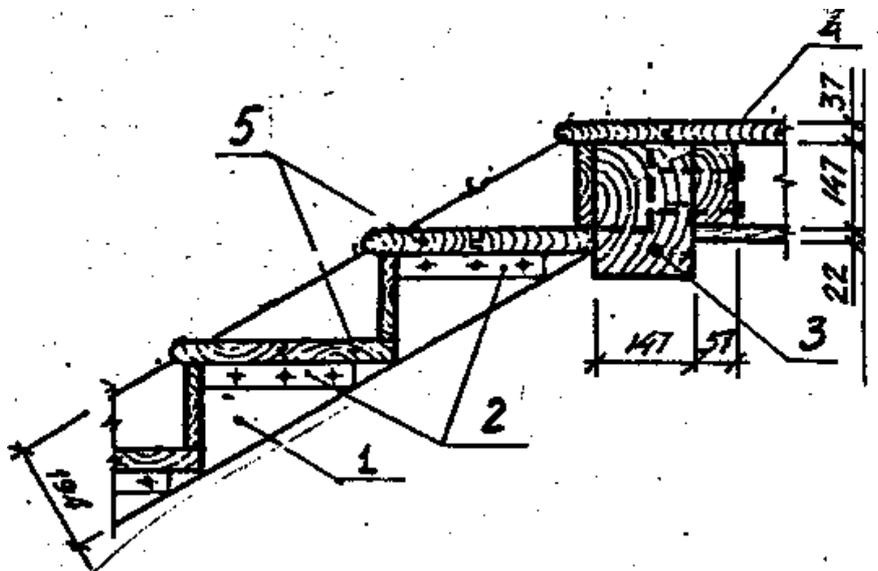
Конструкція сходів по дерев'яних тягивах: 1 - тягива 194x94; 2 - опорні бруски; 3 - поперечна балка 297x147; 4 - сходові площинки з підшивкою; 5 - дерев'яні сходинокки - 37
